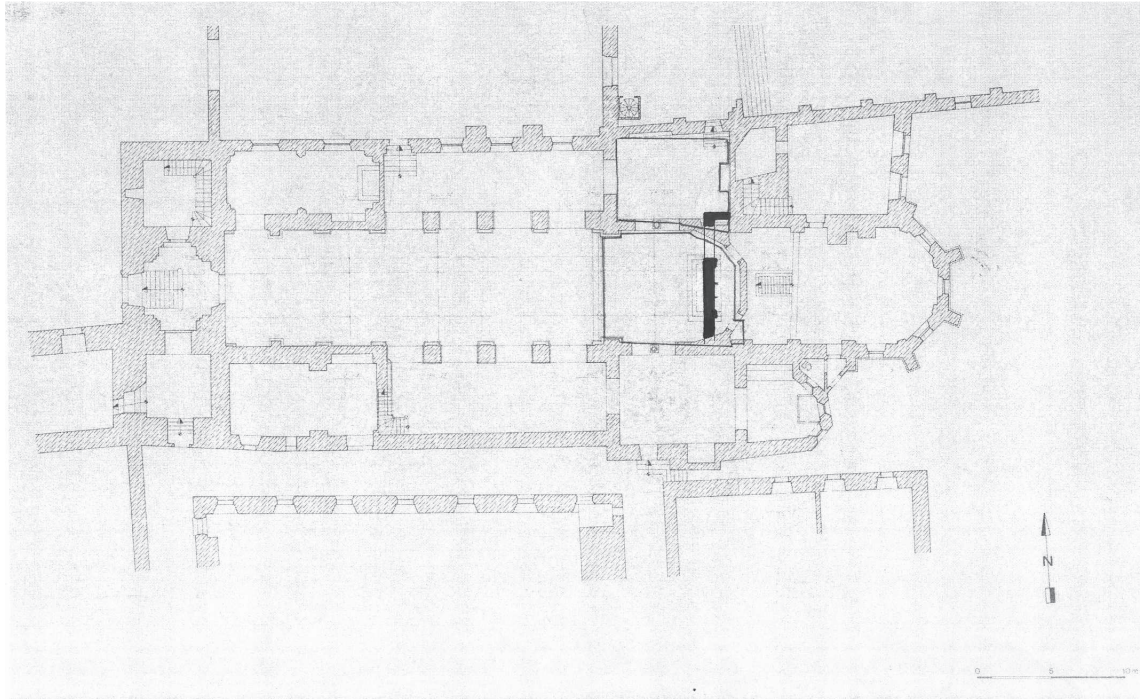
Kreuzkirche, Grundrissplan mit Einzeichnung der ergrabenen Westmauer der ottonische romanischen Krypta. Einzeichnung in Abb. 7.
